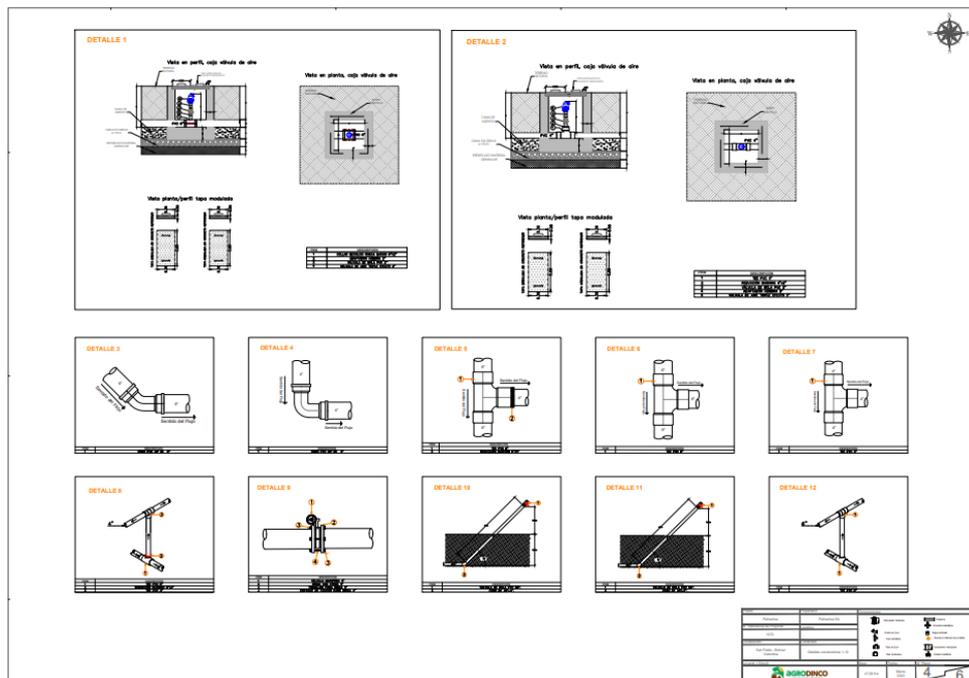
Detalles constructivos del sistema de riego - Proyecto Palmarisa. Fuente: Agrodinco SAS.
